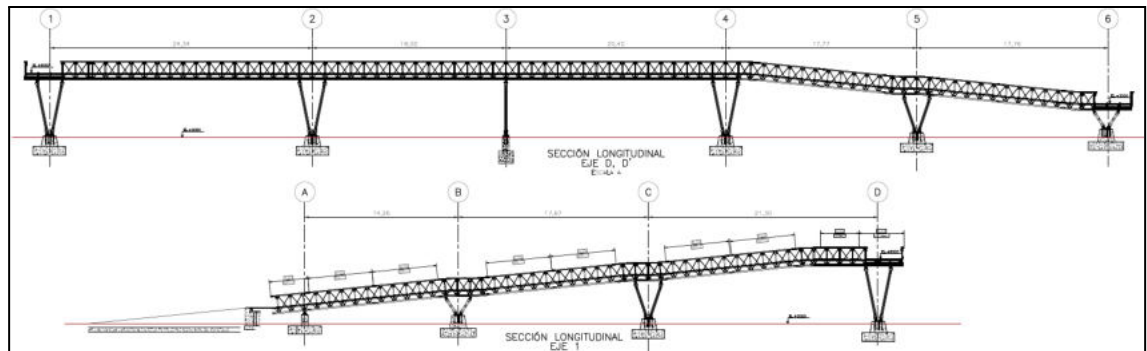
Vista en planta y perfil del puente peatonal sobre la Av.NQS
